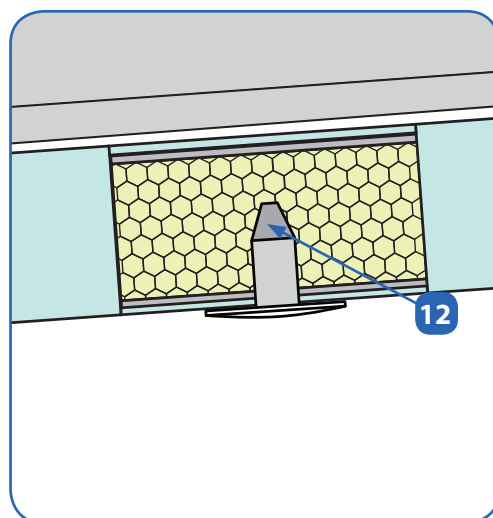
Detalle de la instalación de la tulipa en el panel sándwich.
